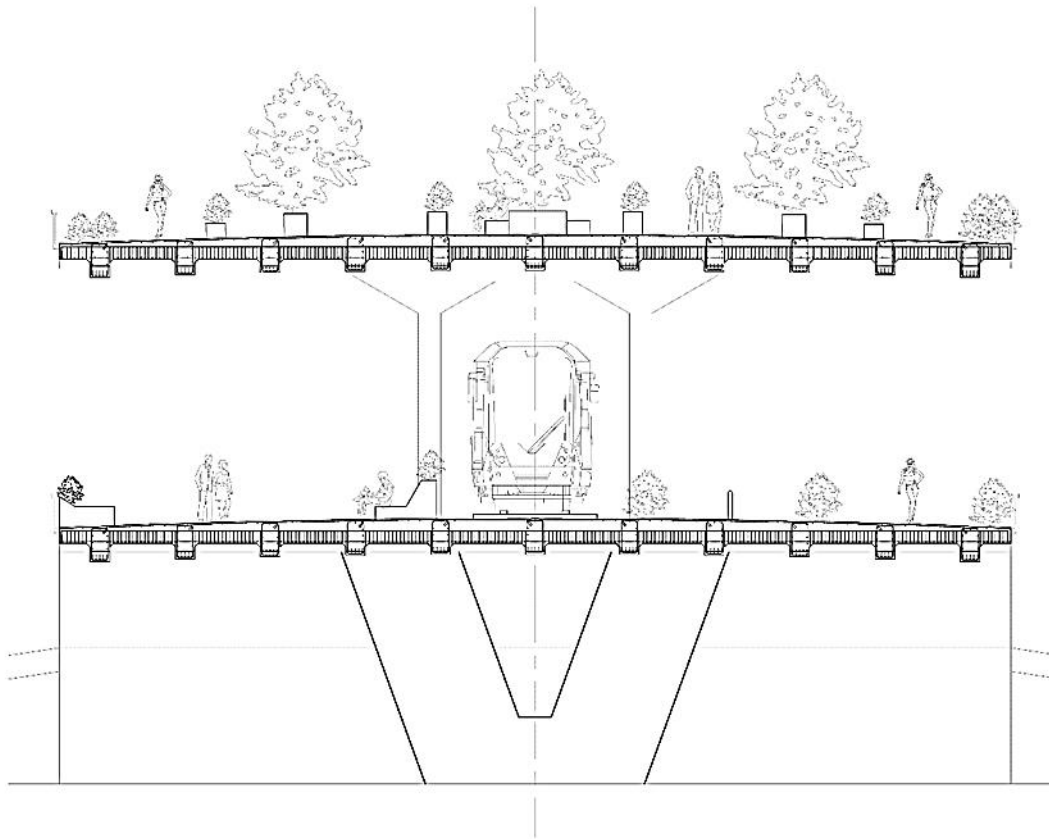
Corte superestructura. Elaboracion propia, (AutoCad).
